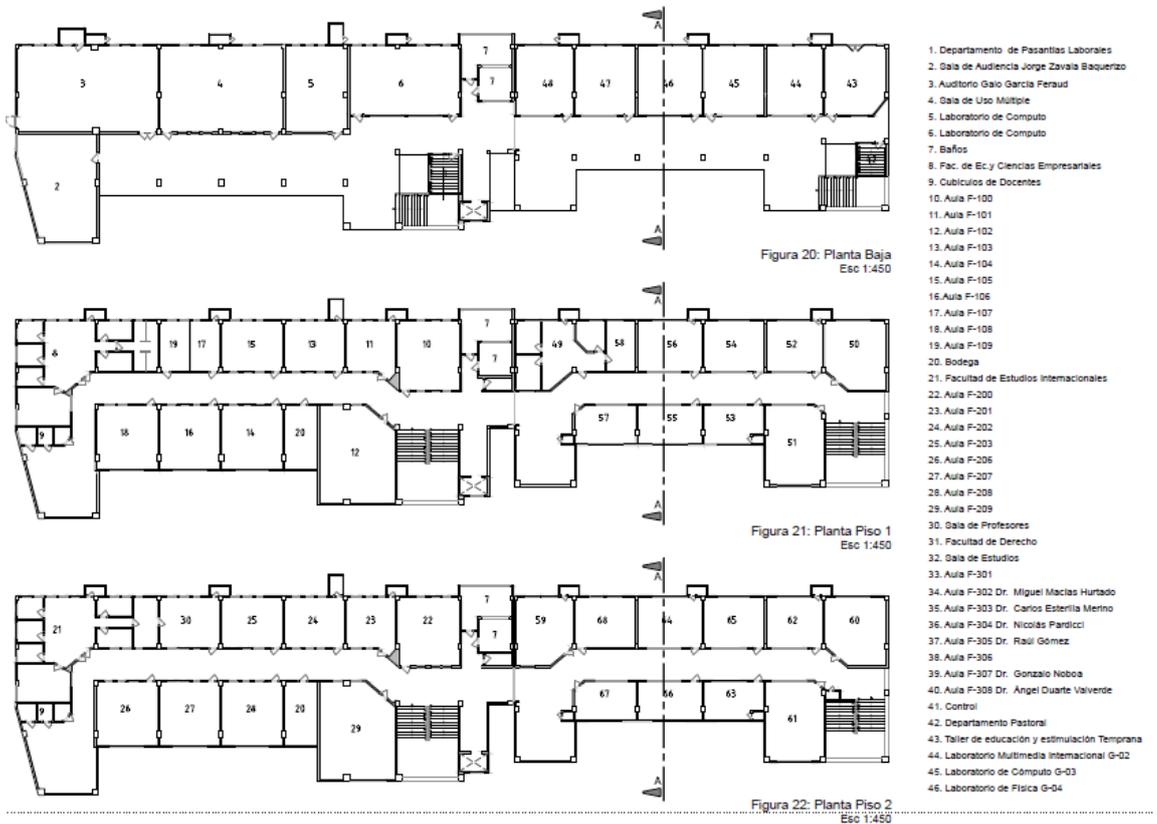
Gráfico 1 Vista arquitectónica edificios F y G, planta: baja, 1 y 2 (Rojas, 2013)
